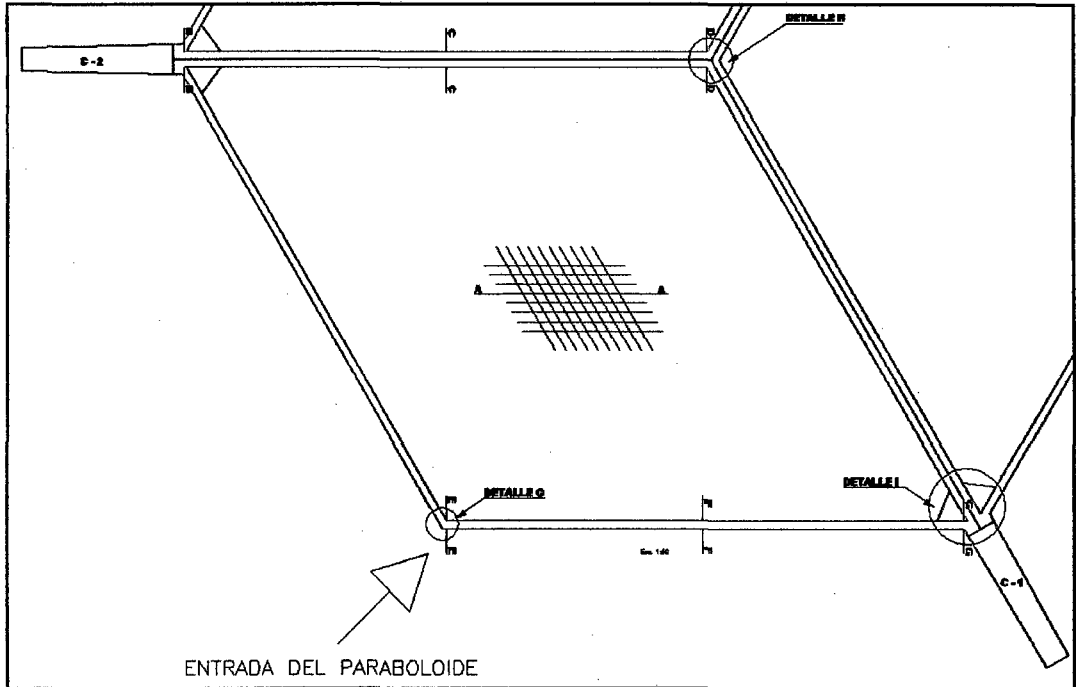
Vista en planta de una parte de la estructura del paraboloide hiperbólico.
